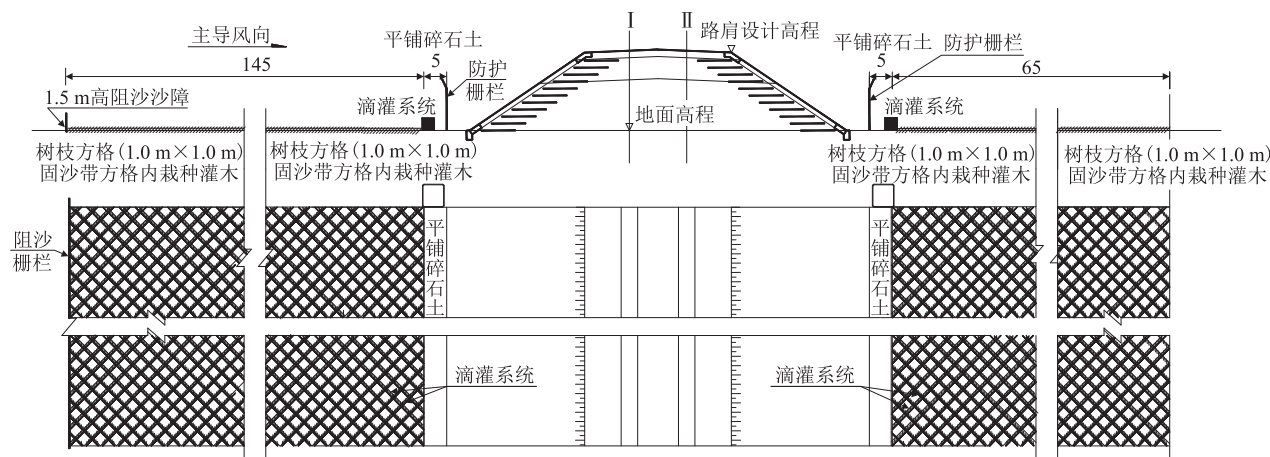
微渗滴灌风沙平面防护试验段横断面和平面布置图(m)
